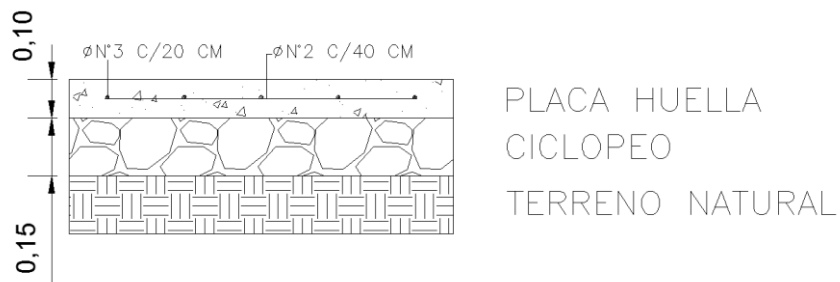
Acero de refuerzo para placas huella (tramo 1)
